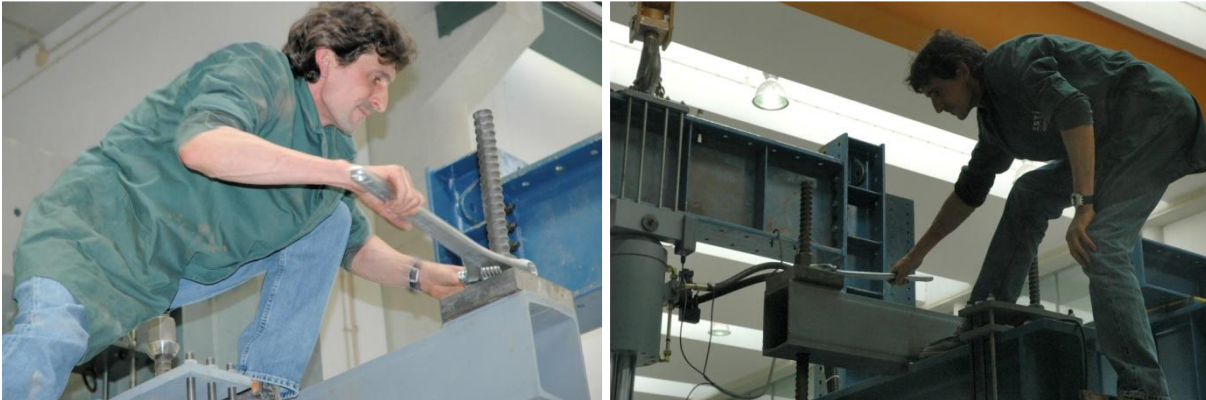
Fixação da viga de carregamento antes de baixar o pórtico
